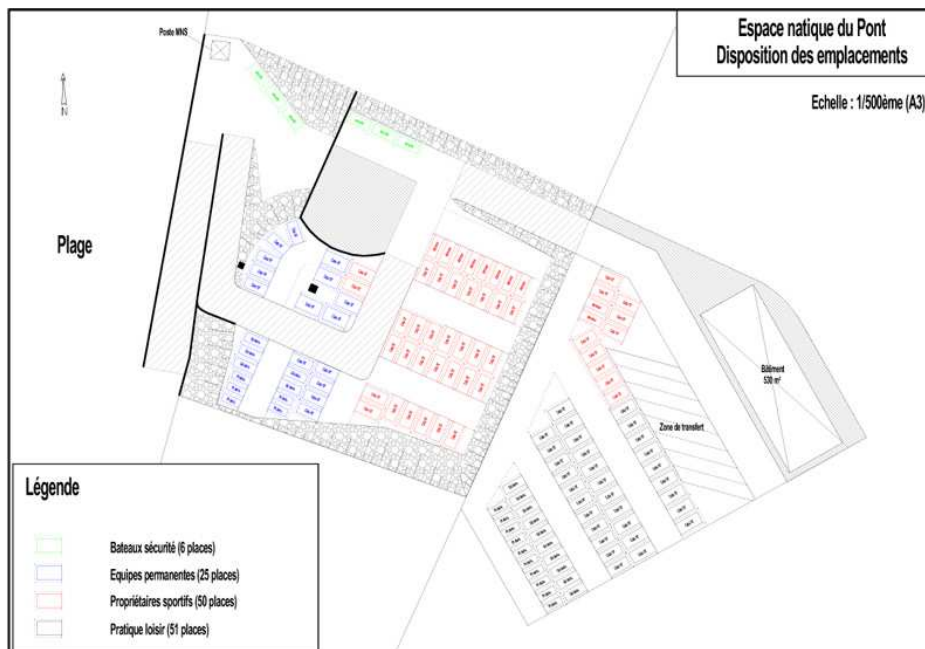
simulation d'un plan de stationnement avec bâtiment d'accueil (source : Créocéan)
